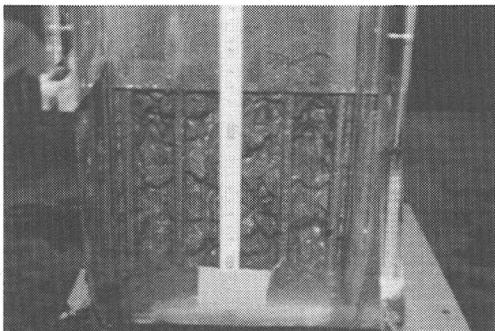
鉄筋間隙部におけるコンクリートの閉塞状況
